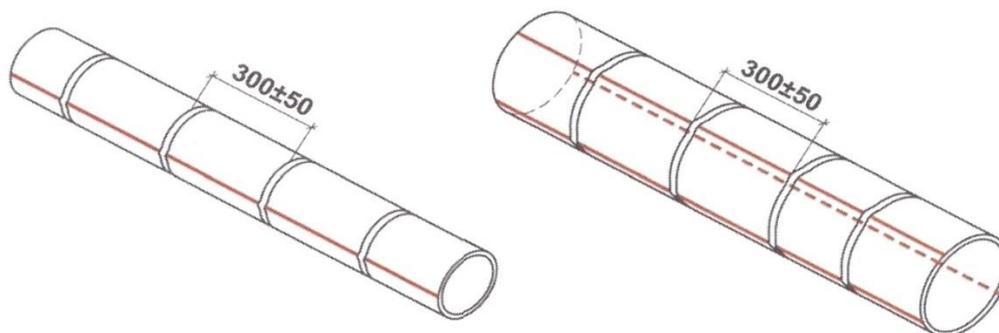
Укладки нагревательных элементов на трубопроводе
